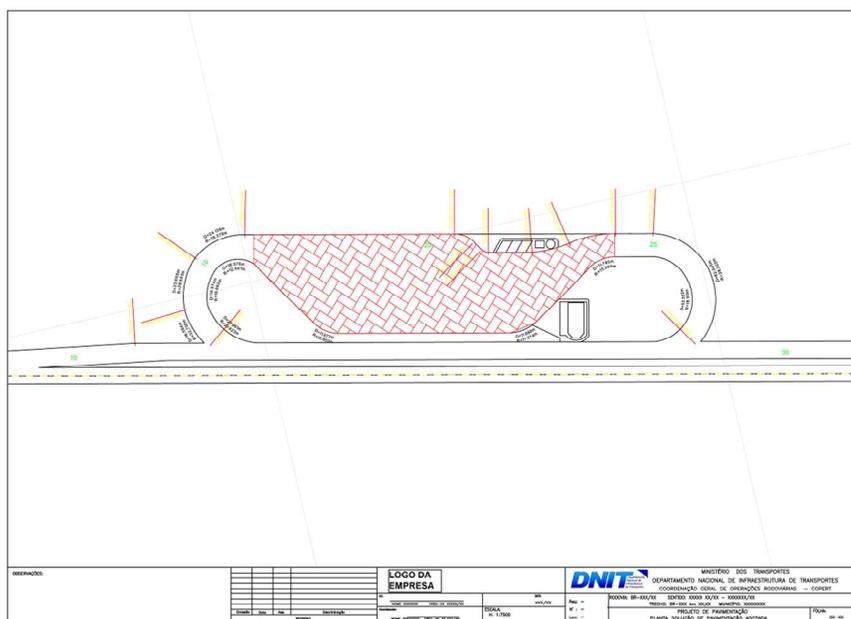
Disposição em planta (layout) da solução de pavimentação.
